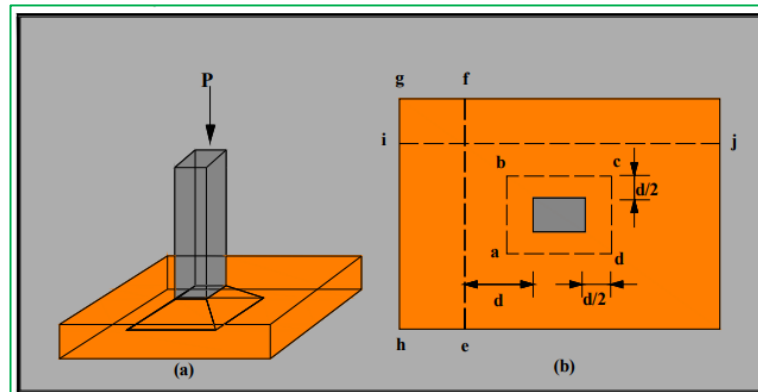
(a) Falla de corte por punzonamiento (b) Secciones críticas por cortante
